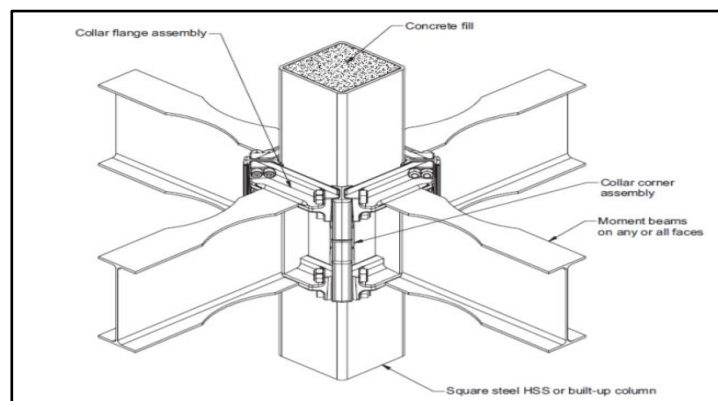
Modelo de conexión ConXtech ConXL AISC358 (2016)
